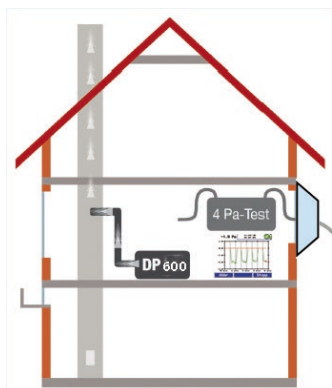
Test sous 4 Pa avec Wöhler DP 600
